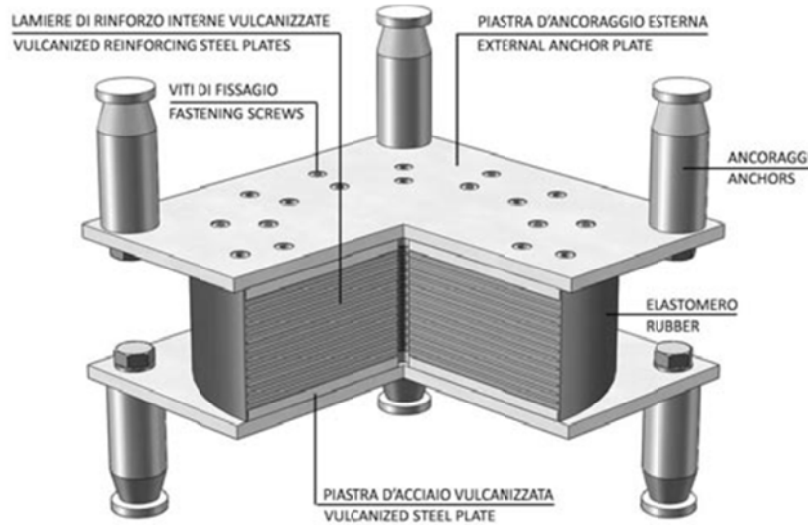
Apoyo de neopreno reforzado (ALGA S.p.A. 2010)
